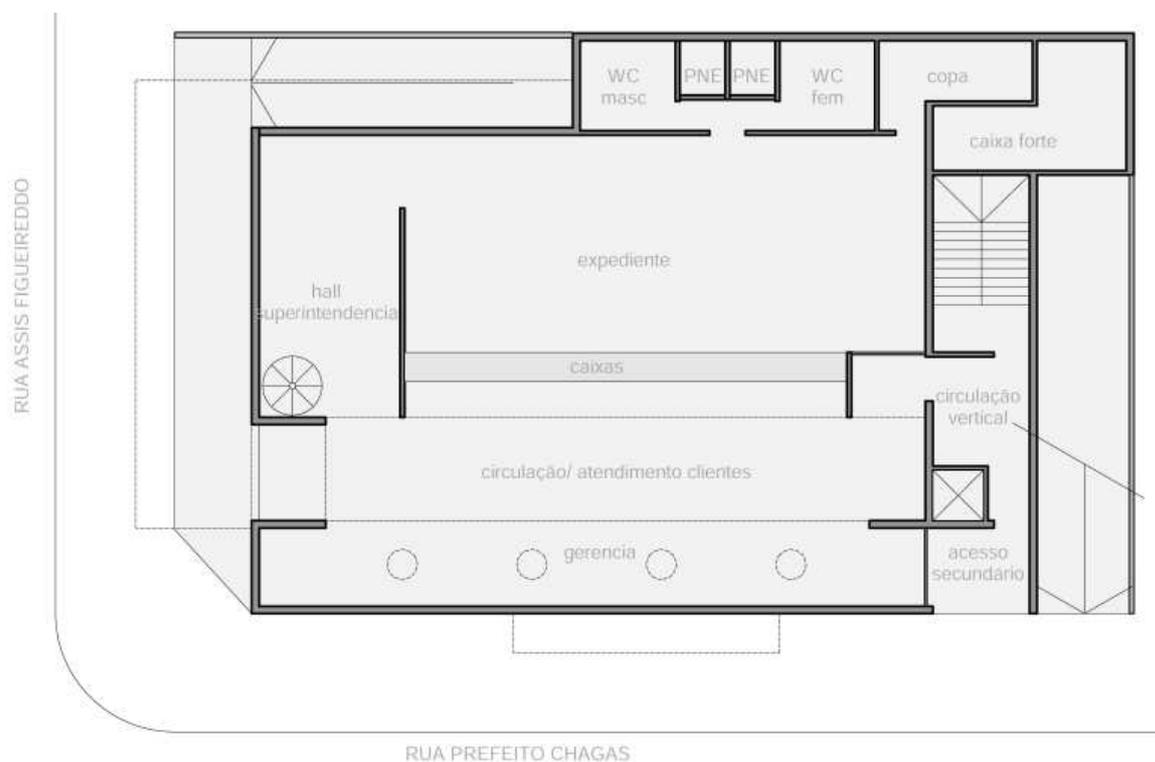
10 - Planta baixa térreo (desenho da autora).
